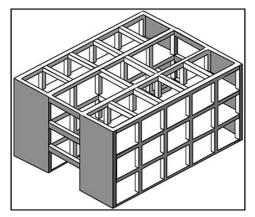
Muros estructurales Exteriores. (fuente: Evaluación, reparación y rehabilitación de estructuras de concreto)
